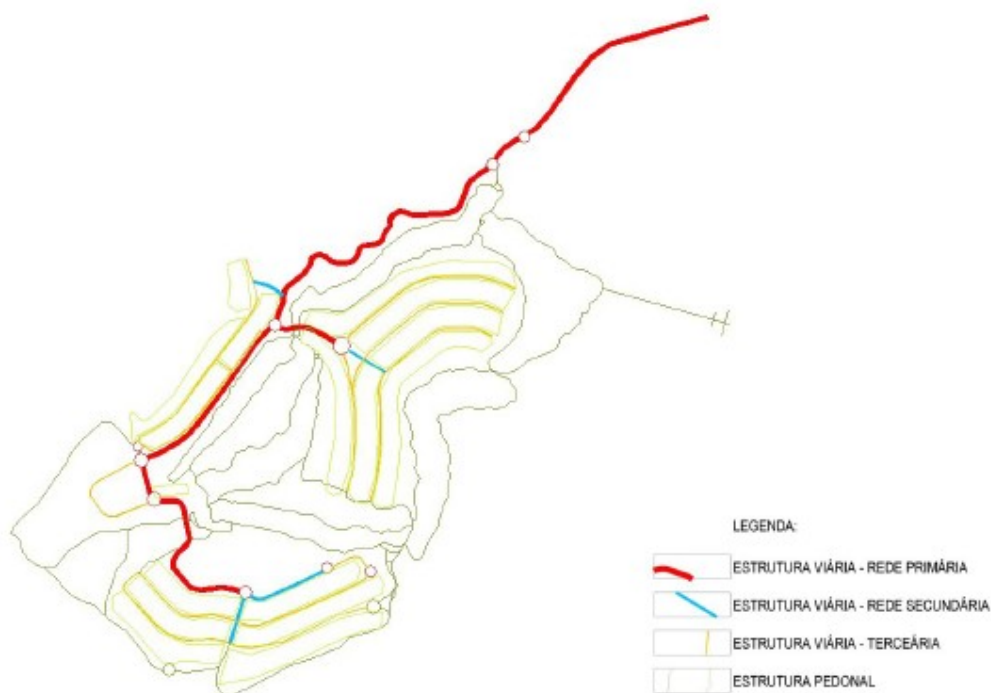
Estrutura viária do plano (fonte: Autor)
